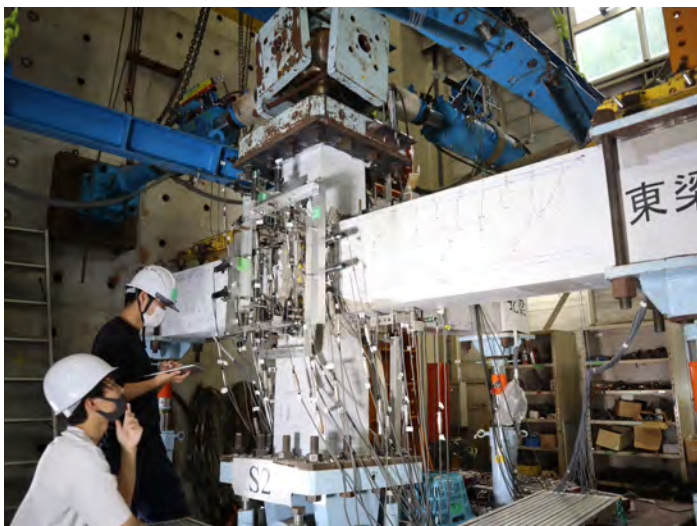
鉄筋コンクリート外周柱梁部分架構の実験
